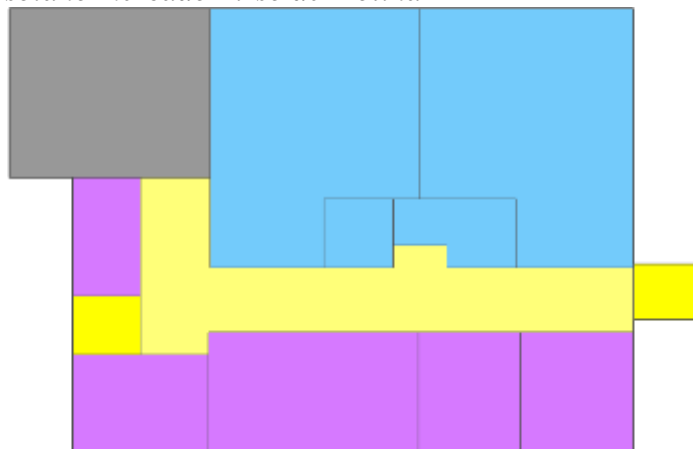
Planta estructural mercado Tirso de Molina.
